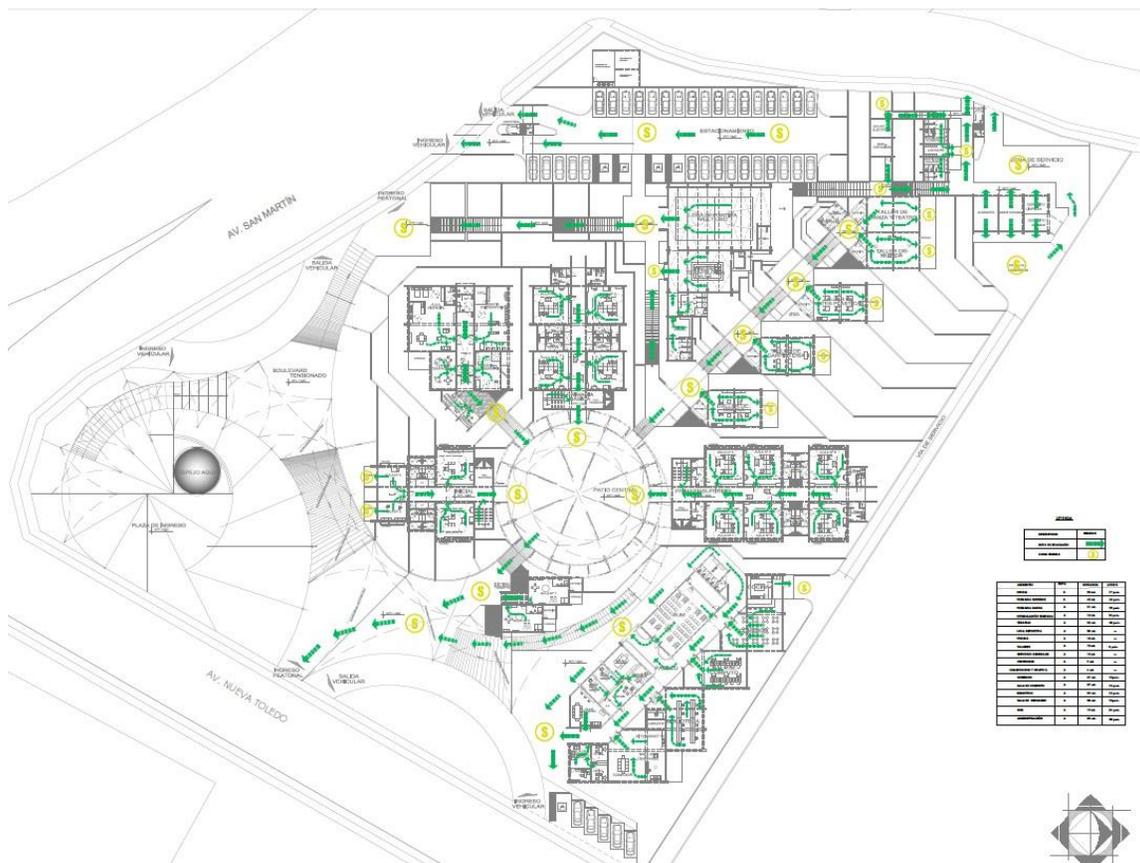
Plano de evacuación de primer piso. Fuente Elaboración propia.
